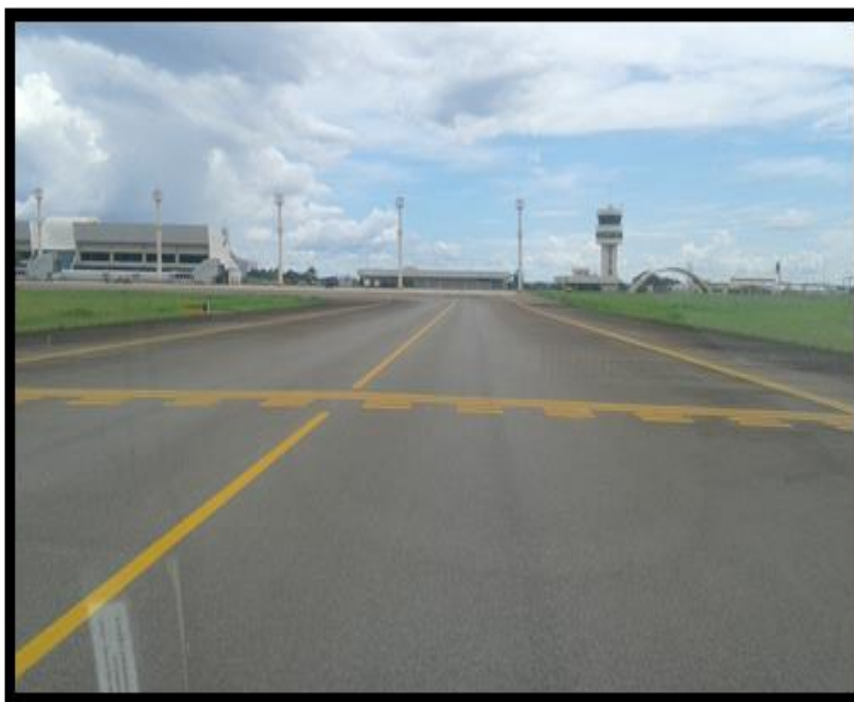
saída de pista de pouso e decolagem para pátio de aeronaves (*fillets*).
